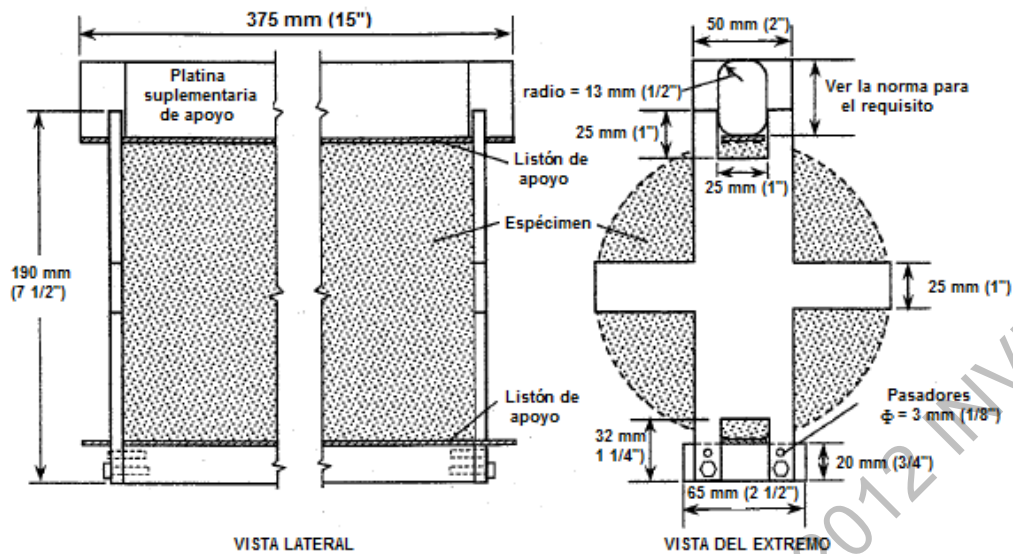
4. Plano detallado de una plantilla adecuada para alinear cilindros de 150 × 300 mm (6 × 12")
